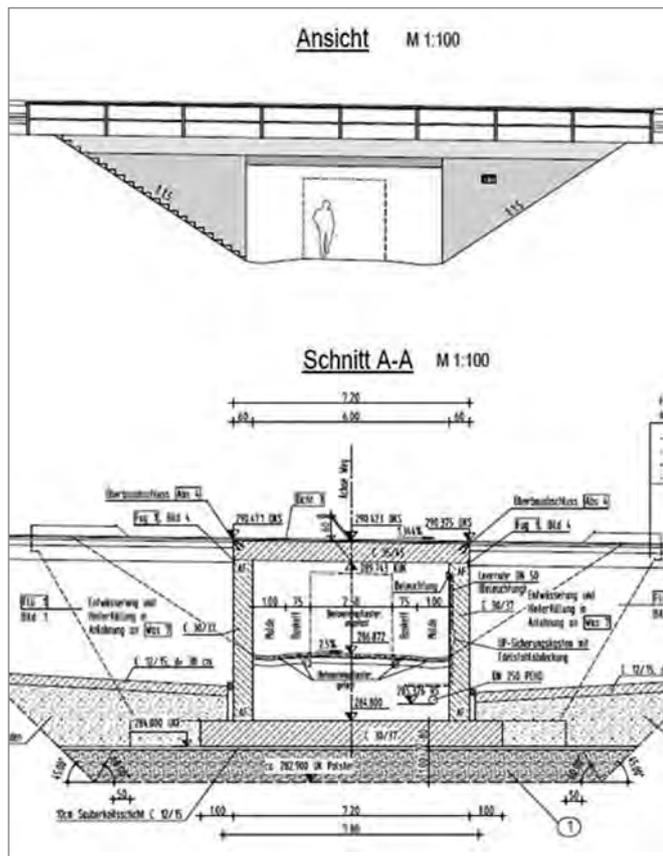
Ansicht und Längsschnitt Brückenentwurf Bw 2
